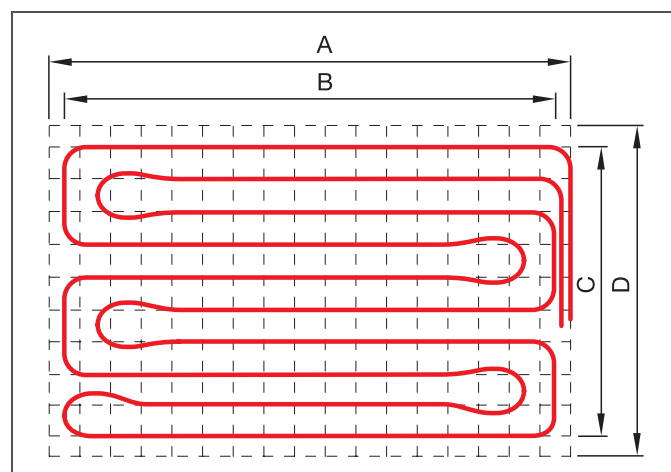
Размеры для укладки, укладка для подсоединения справа
